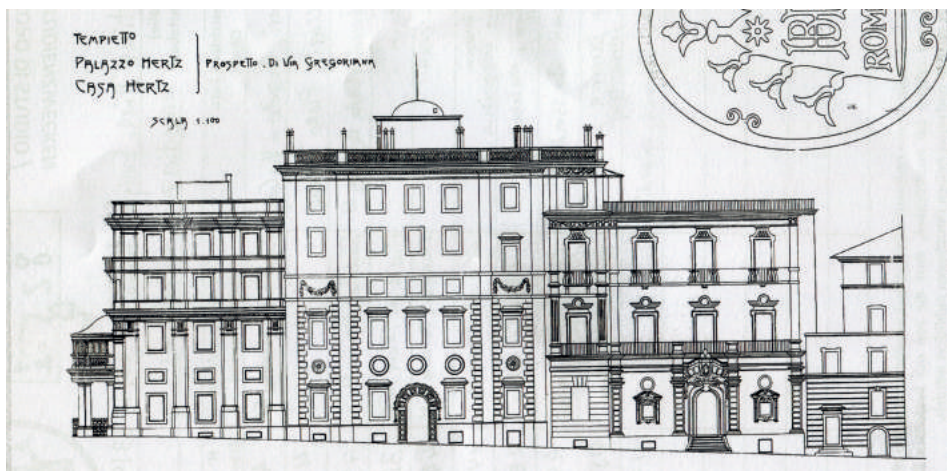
Proyecto de los años 60. Plano fachada del Palacio Zuccari, Via Gregoriana, Canizaro Mariano ed.
